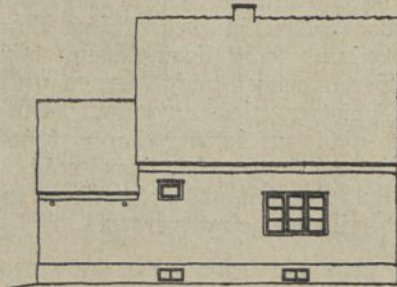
3. Kleinstes Einfamilienhaus „Damaschke“
